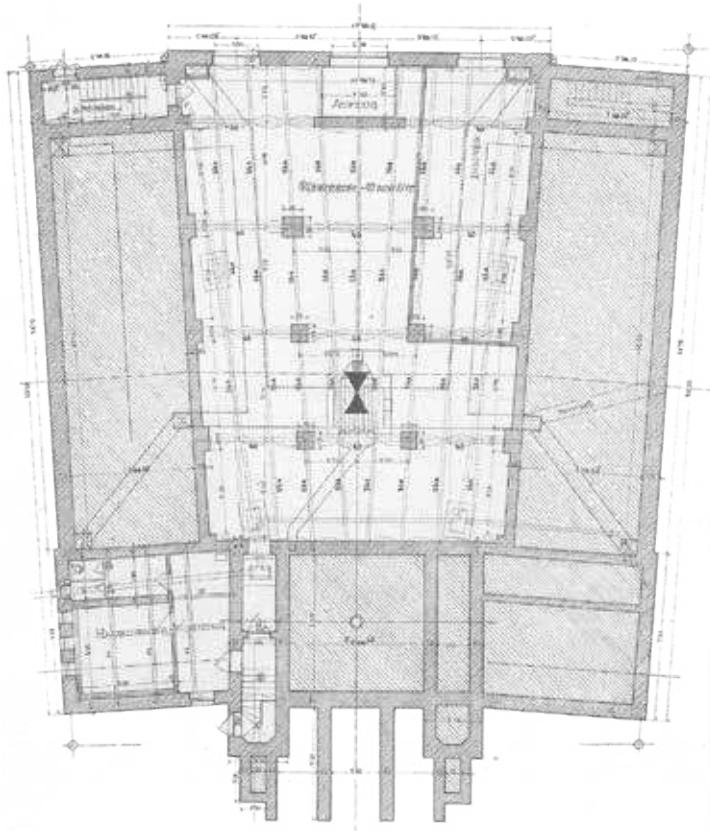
Grundriss Untergeschoss Maßstab ca. 1:350
